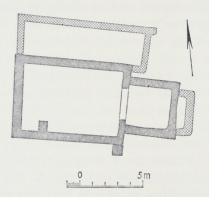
Balkhausen. Grundriß der Saalkirche und der Erweiterung. Maßstab 1:300.
